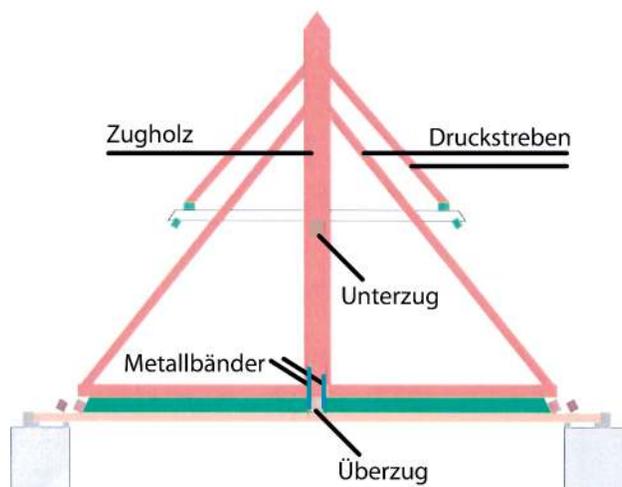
Hängewerk im Dachraum über dem Hauptschiff; 3D-Modell und Zeichnungen: Hamm Architektur + Denkmalpflege, Worms
